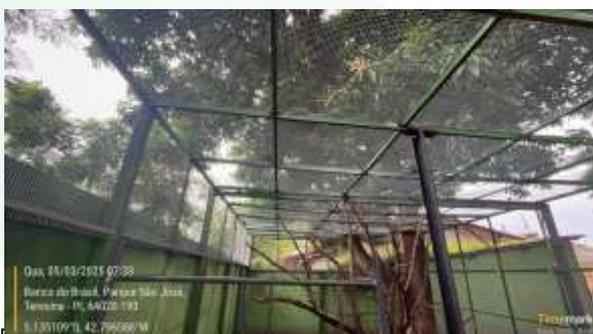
Construção de viveiro de aves de 60 m² em blocos de concreto estrutural e tubos de metalon soldados no Centro de Recreação e Reforço Infantil.
